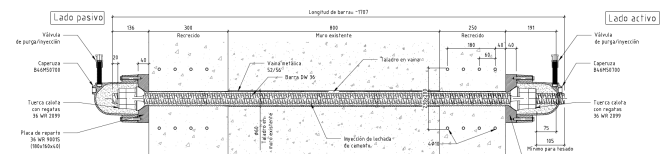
Detalle anclaje adherente barra Dywidag 36WR en núcleos
